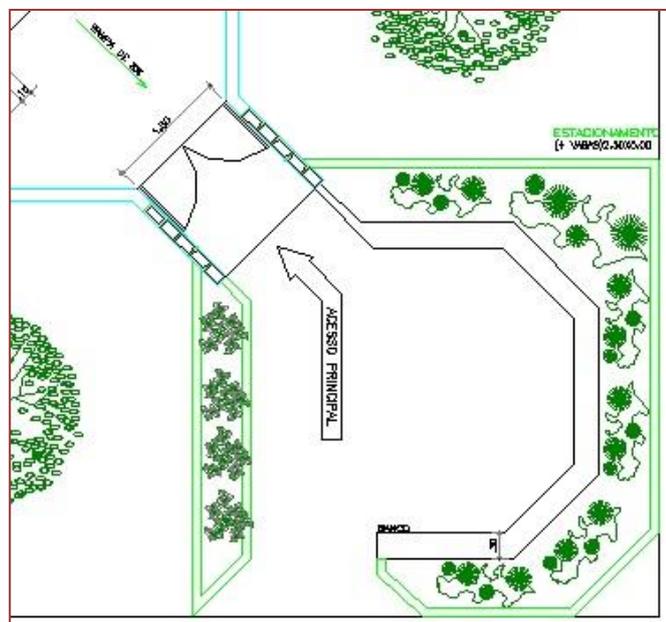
Planta Baixa da entrada - Hall. Fonte: Pesquisadora.
